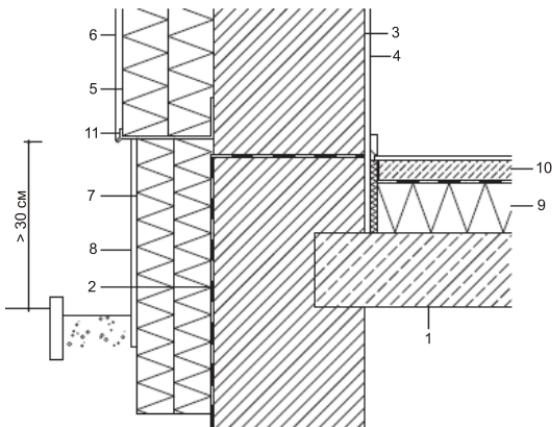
Теплоизоляция бетонного перекрытия сверху, устранение
